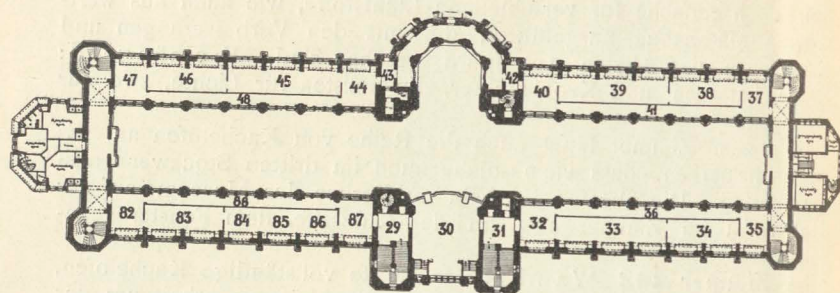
Grundriss des zweiten Stockwerkes.
